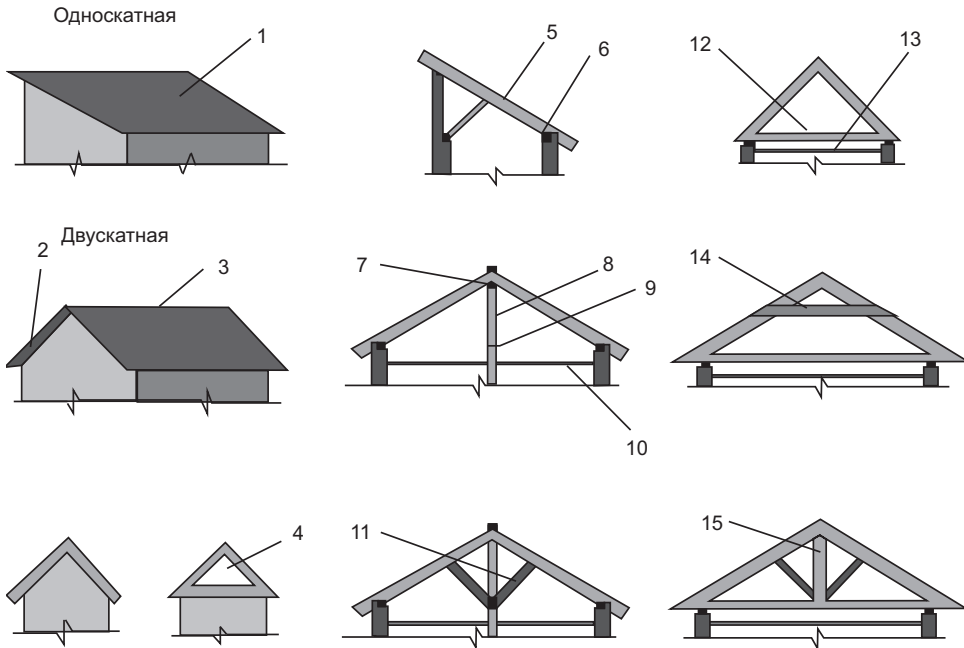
Стропильная система для односкатной и двускатной крыши: 1 — скат; 2 — карниз; 3 — конек; 4 — тимпан; 5 — стропило; 6 — мауэрлат; 7 — коньковый прогон; 8 — стойка; 9 — лежень; 10, 13 — перекрытия; 11 — подкос; 12 — затяжка; 14 — ригель; 15 — балка
